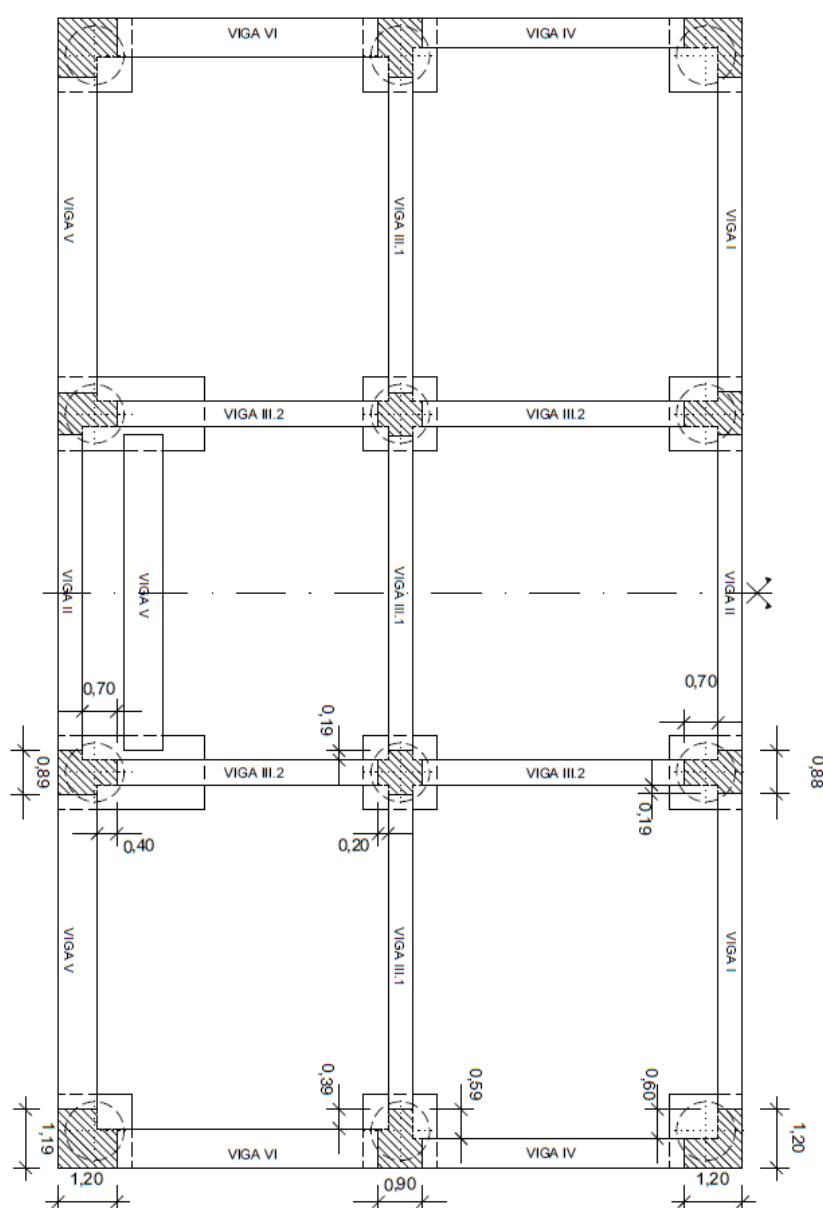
Situación de las esquinas hormigonadas en segunda puesta.
